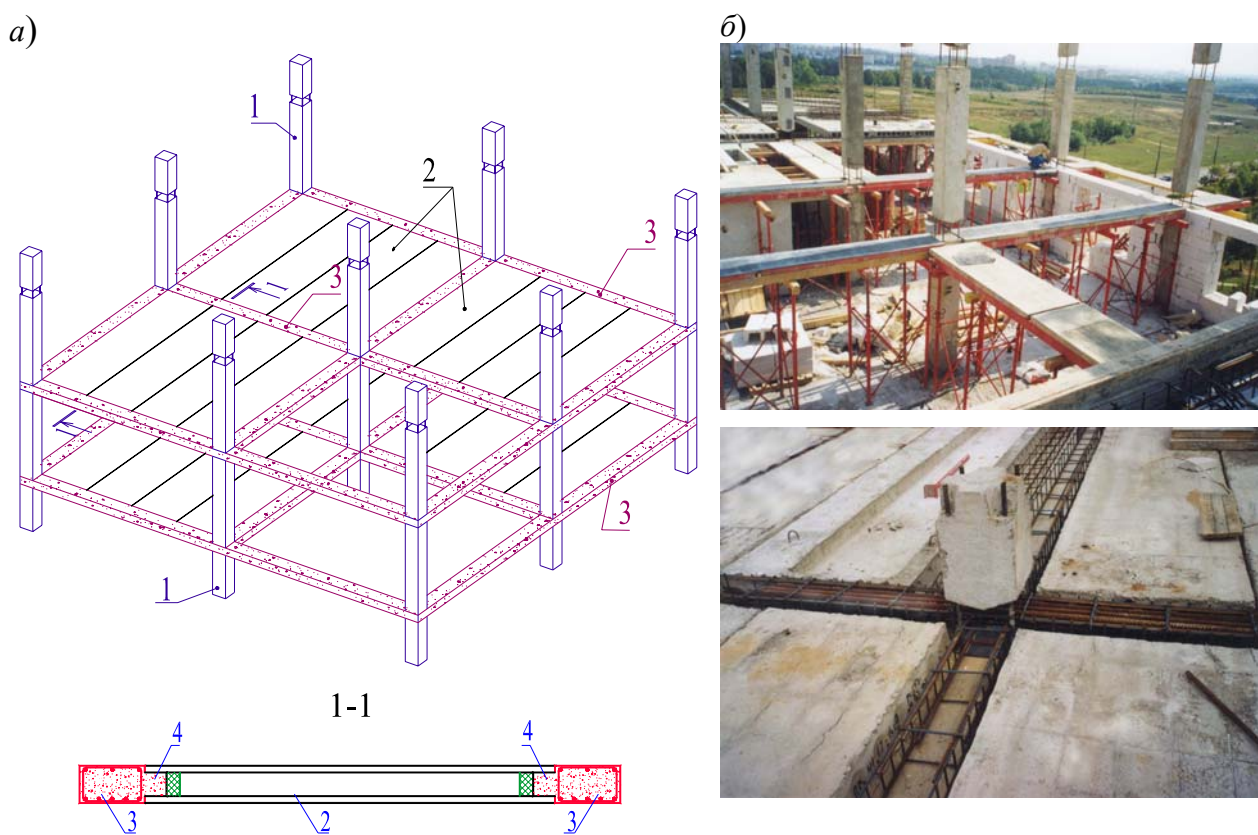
Сборно-монолитный каркас многоэтажного здания системы АРКОС с плоскими дисками перекрытий: а) – схема каркаса, б) – здание в процессе строительства.
